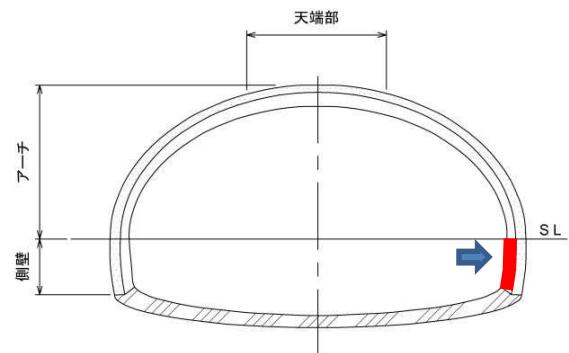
インパート拘束による横断方向のひび割れ
